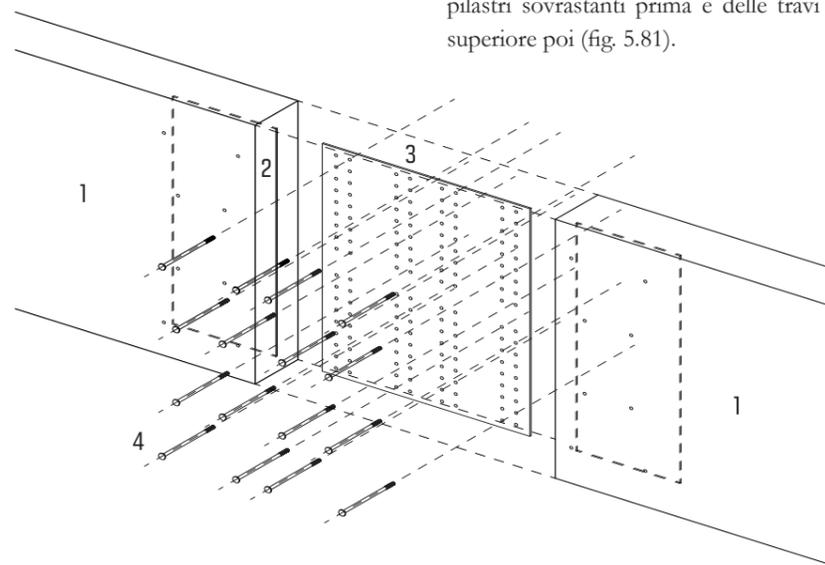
DETTAGLIO DI ASSEMBLAGGIO DELLE TRAVI DI FONDAZIONE
